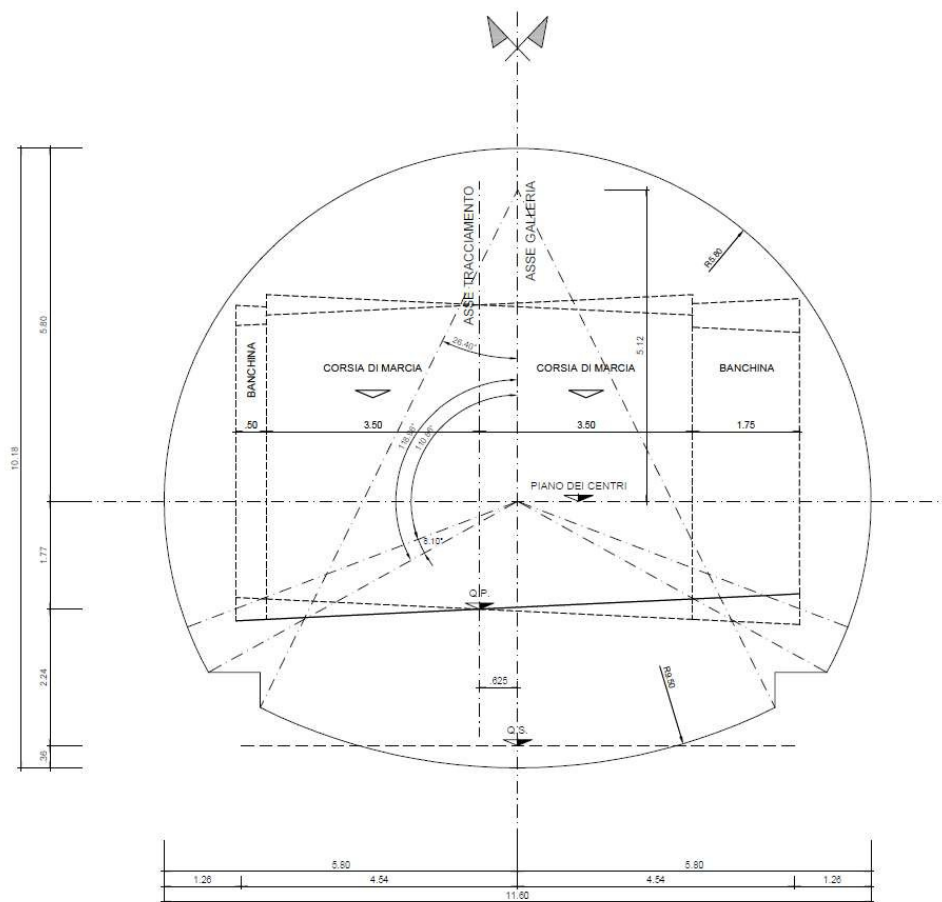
Sezione tipo funzionale galleria Picchiarella.
